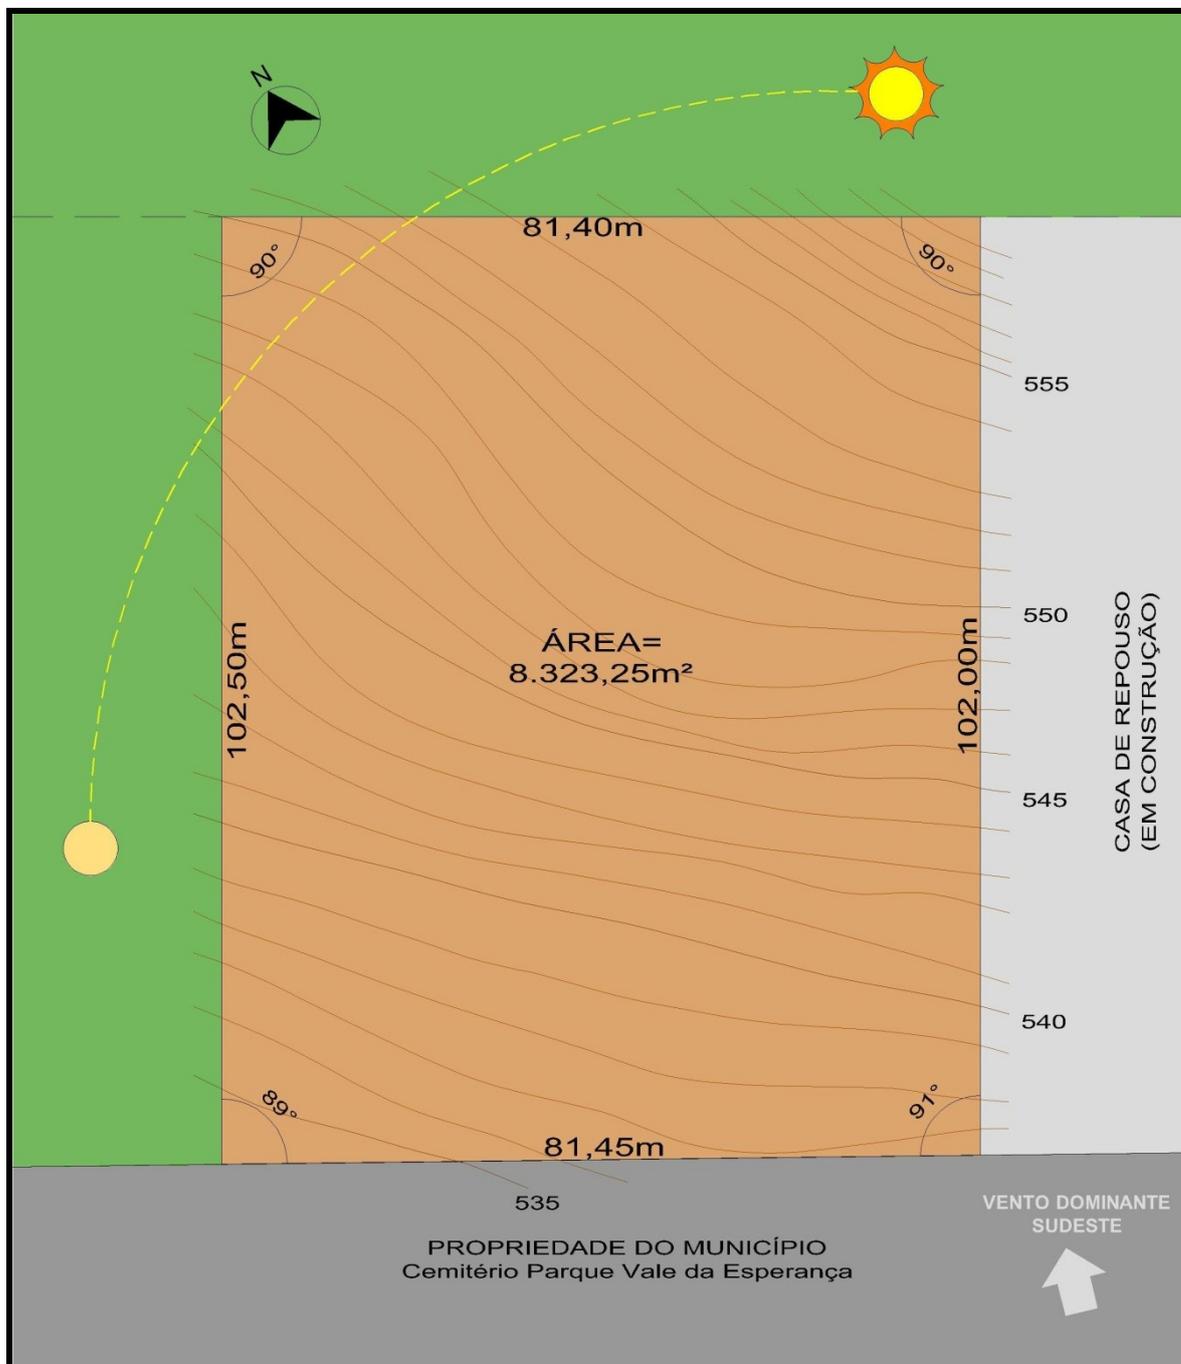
Planta de Situação e Planialtimétrico (AUTORA, 2011)
